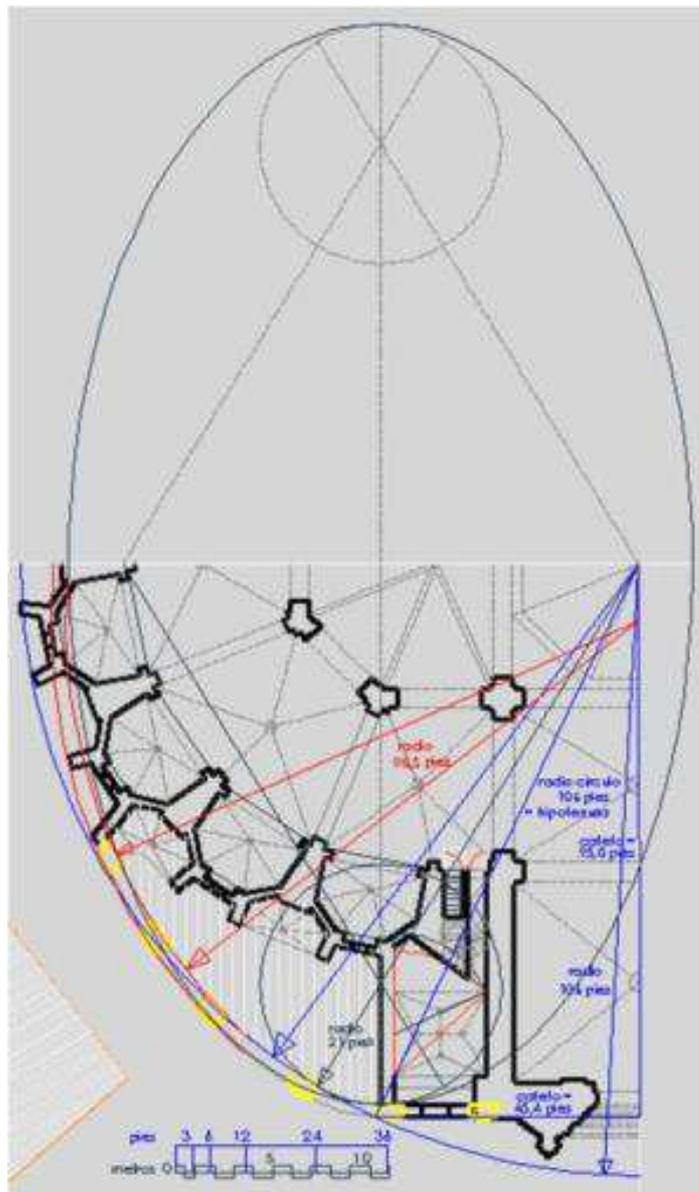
17.6 Geometría general real del trazado de la planta con los distintos centros.
